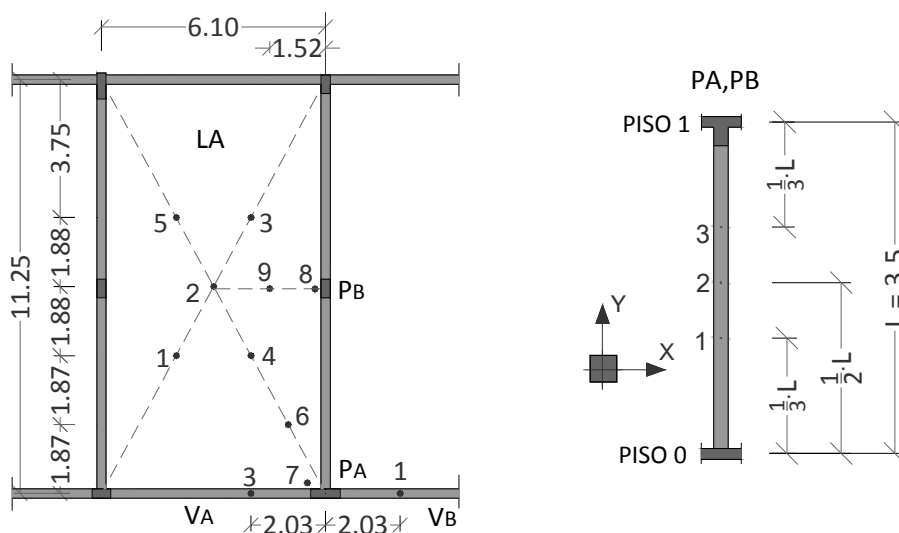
Elementos estruturais do edifício da escola ensaiados
